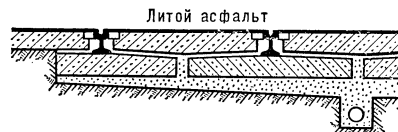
Верхнее строение трамвайного пути на основании из бетонных плит.
